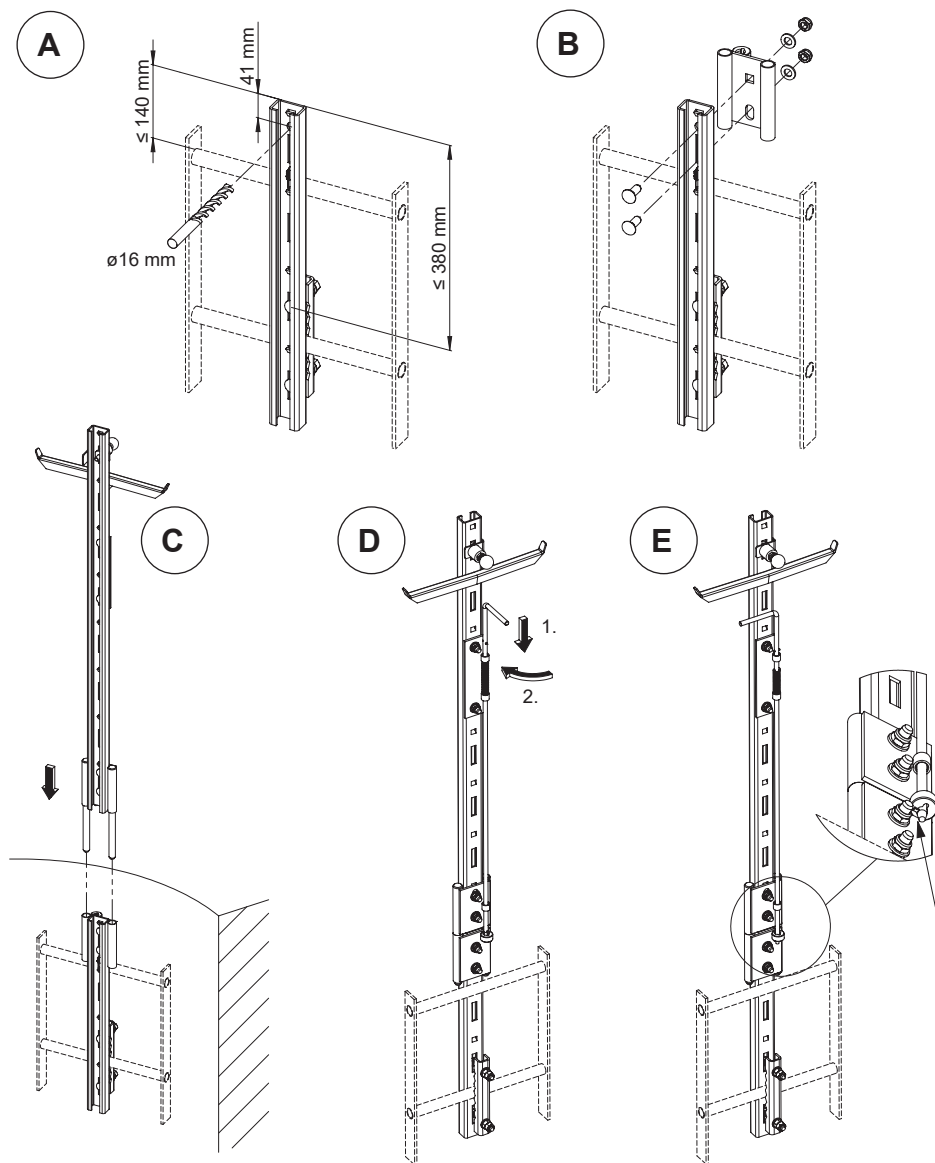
Montering aksel inn i enheten: A: Drilling og dimensjoner
